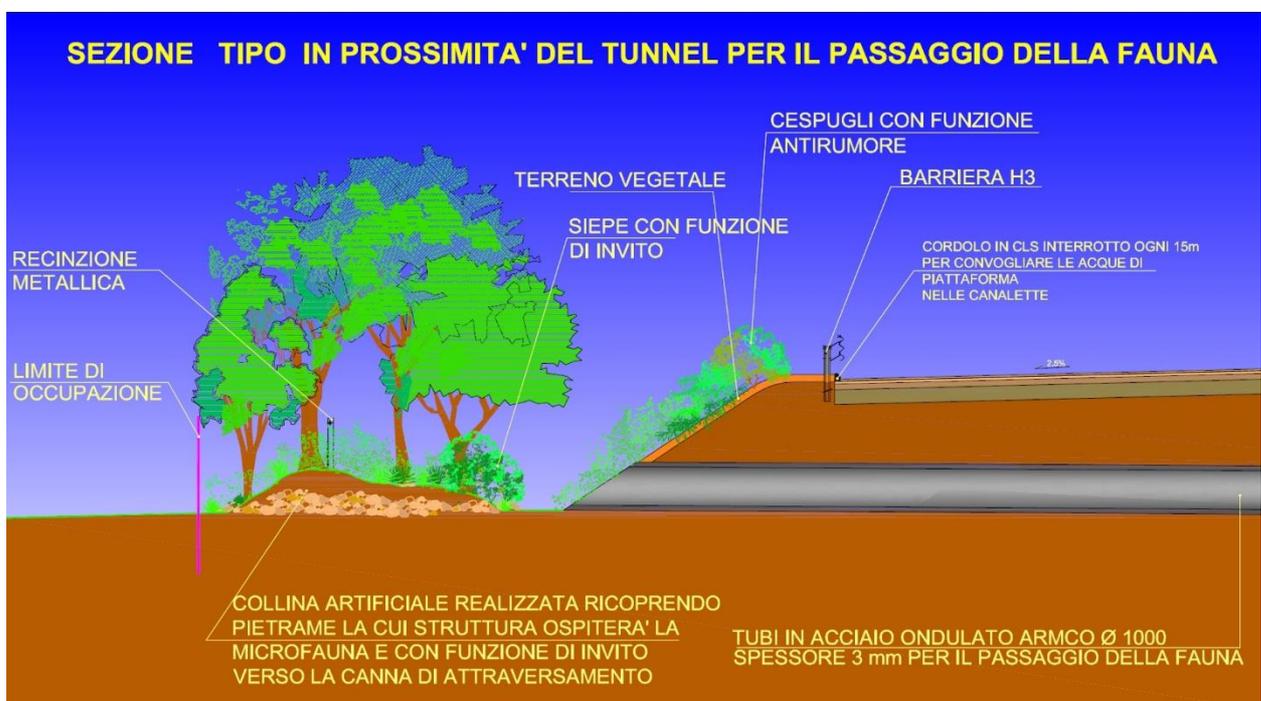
Sezione tipo in prossimità del tunnel per il passaggio della fauna
